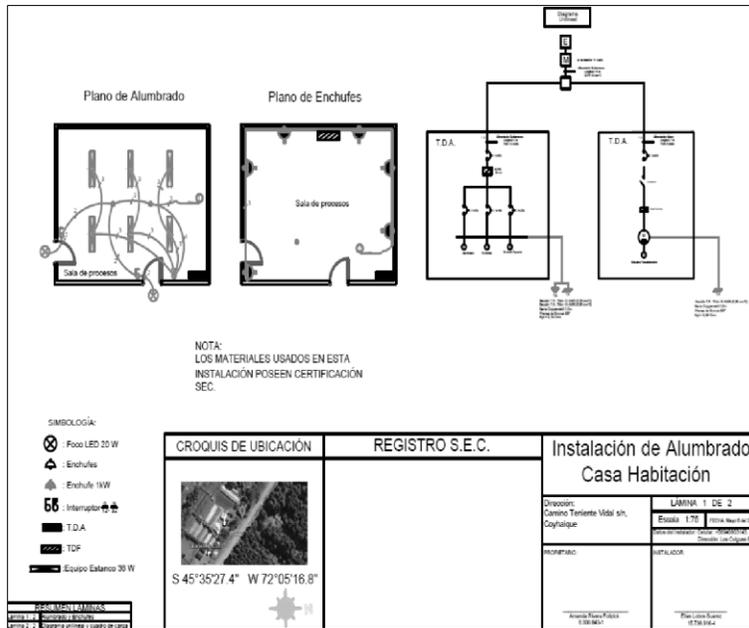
Plano eléctrico de la planta de procesos lamina A. Detalle del plano de alumbrado, enchufes y diagrama lineal de tablero de alumbrado y fuerza.
